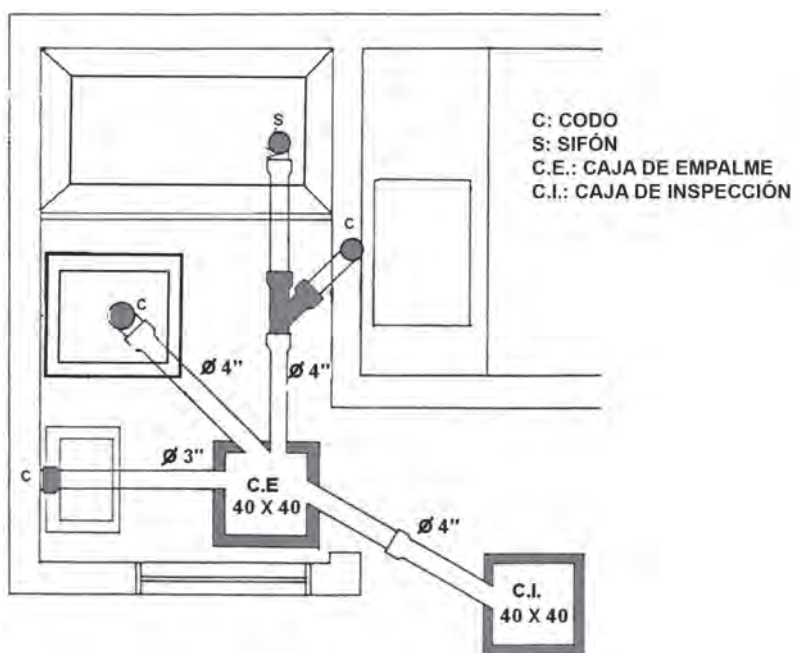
Planta de distribución para el sistema de desagüe en una pequeña planta de procesamiento.
